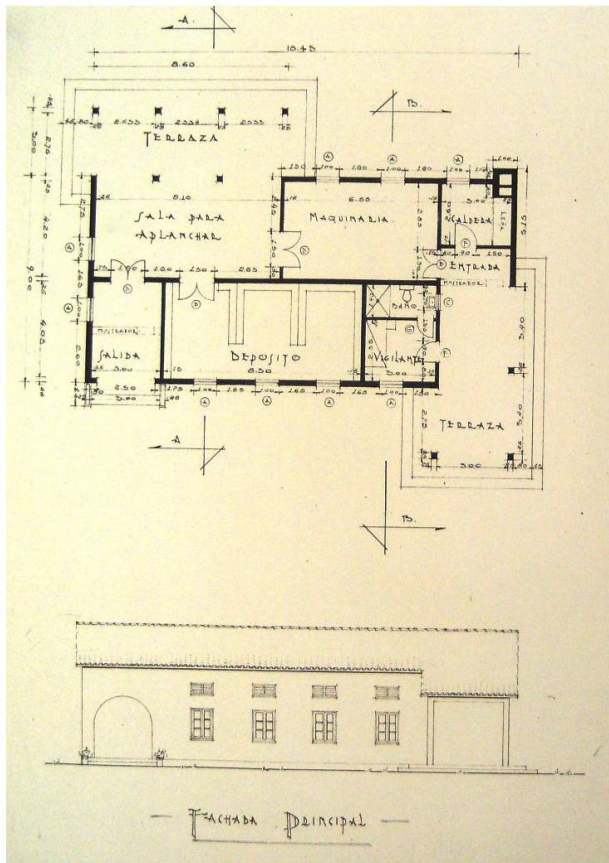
Links: Wäscherei des Krankenhauses, Grundriss und Ansicht. Abb. 171 Rechts: Ausschnitt des linksseitigen Grundrisses mit Rothers Unterschrift. Zu beachten sind die Türbögen und die übereinander liegenden Fenster für die Durchlüftung.
